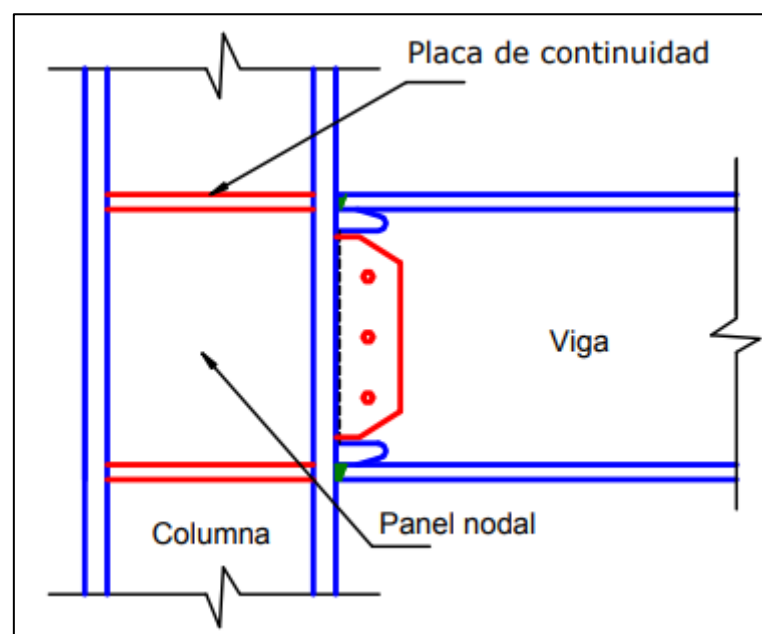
Detalle de placa de continuidad en conexión viga-columna. En Crisafulli (2018).
